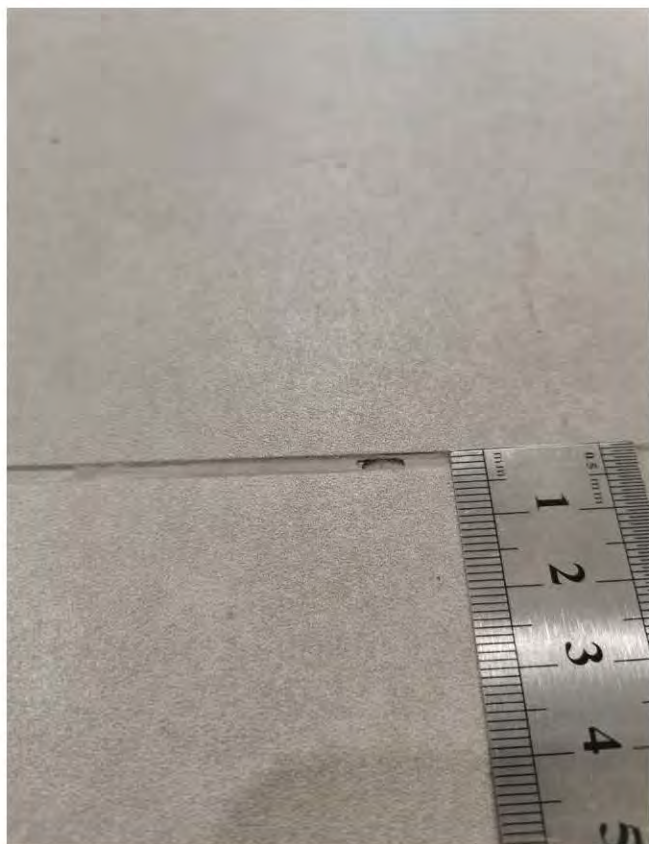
Коридор (3,2 кв.м.) 1.8 Некачественная затирка швов на напольной плитке
